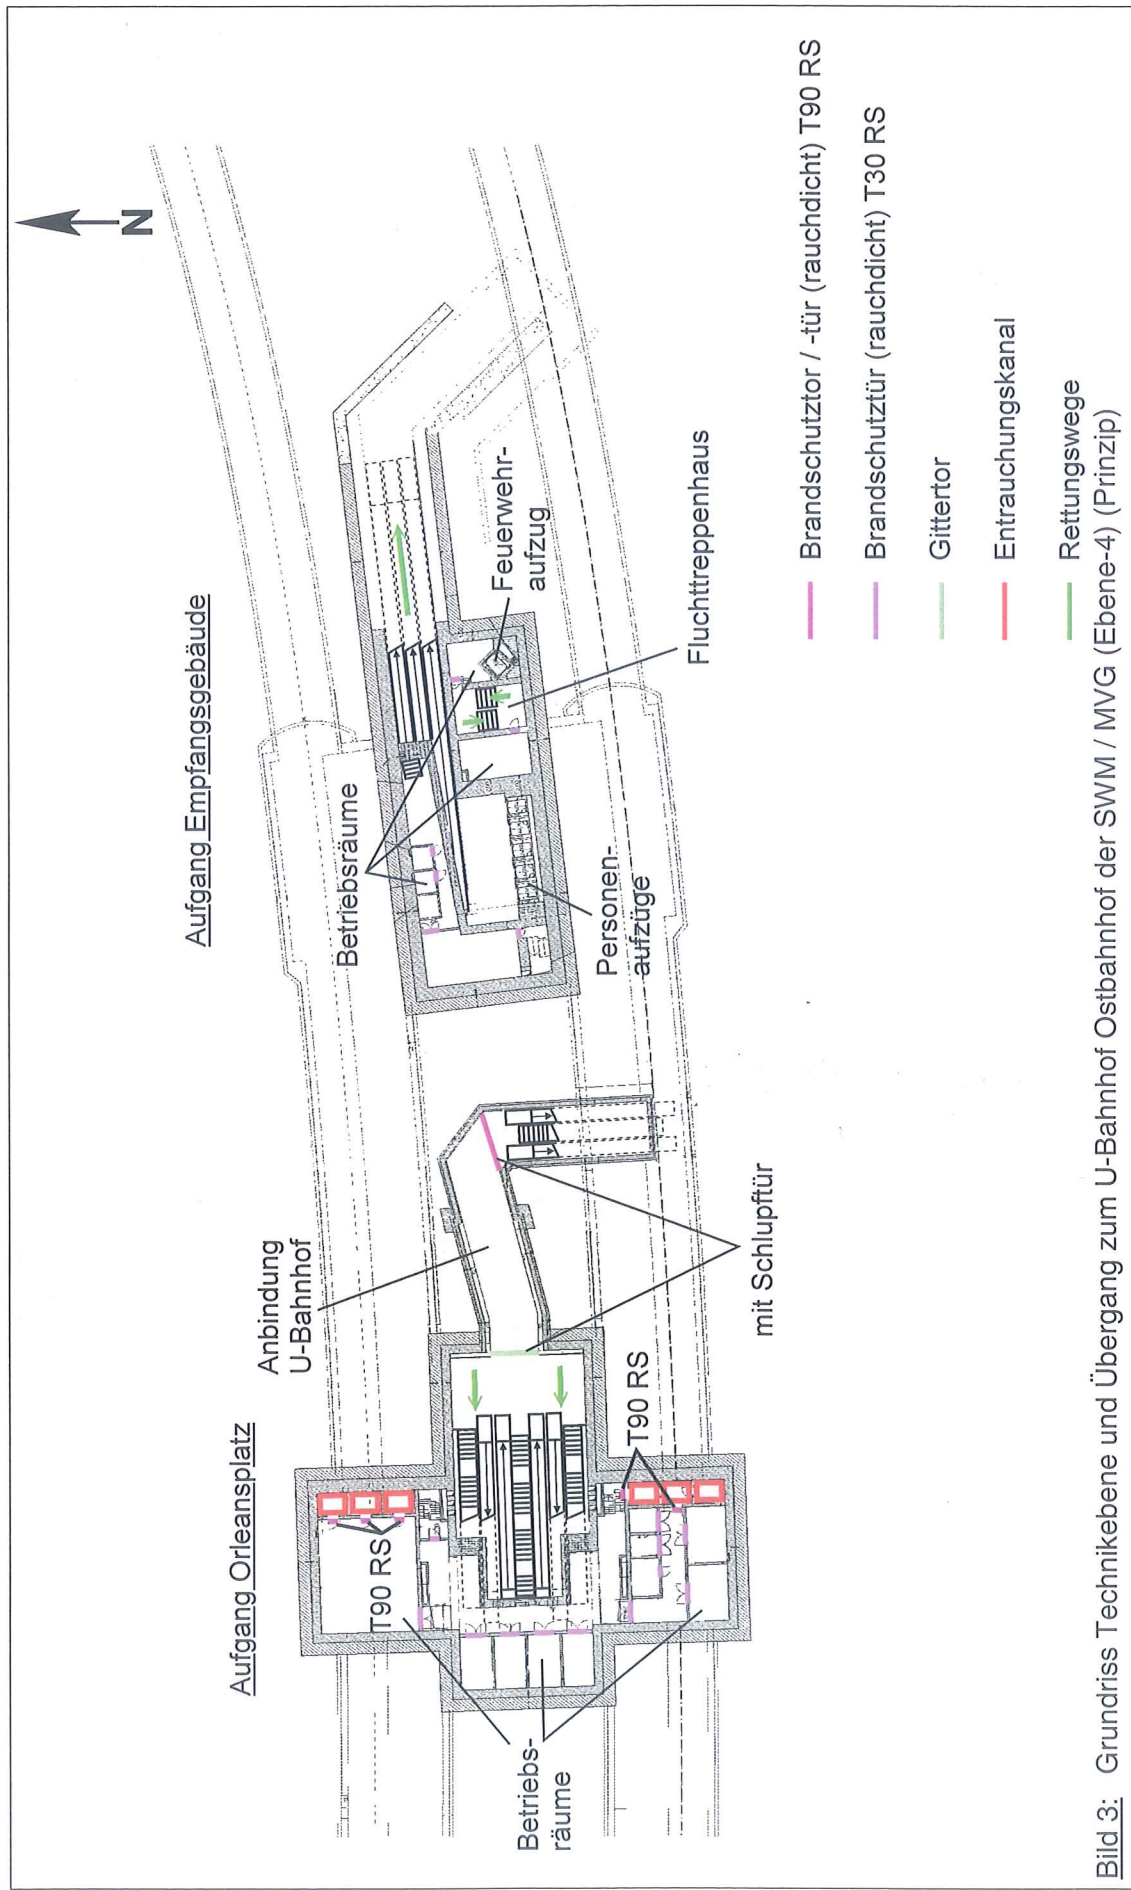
Grundriss Technische Ebene und Übergang zum U-Bahn Ostbahnhof der SWM / MVG (Ebene-4) (Prinzip)
